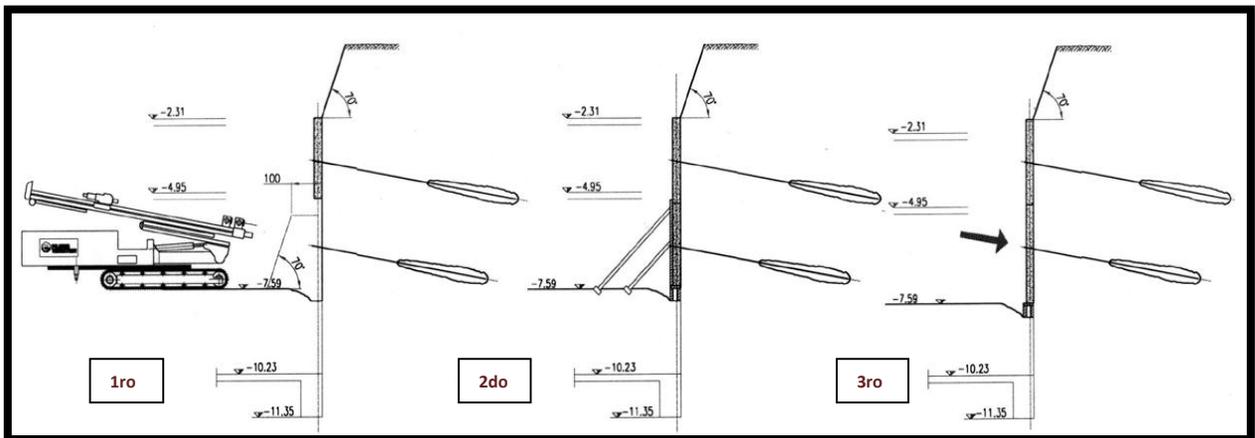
Secuencia Resumida del Proceso: 1ro. Perforación, inyección y anclaje, 2do. Construcción del muro (acero, encofrado y concreto) y 3ro. Tensado del anclaje
